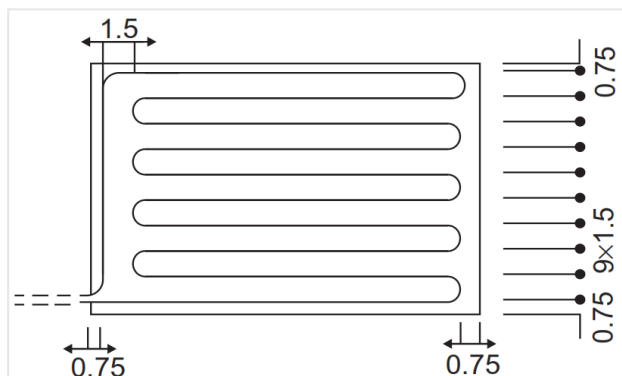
Disposition horizontale des serpentins pour le refroidissement du béton
